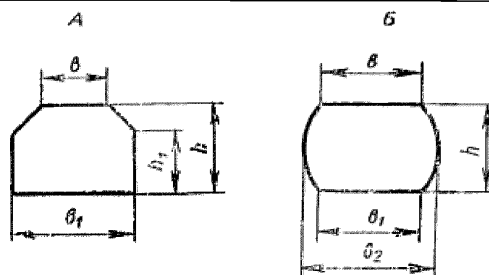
Поперечное сечение деревянных брусьев для стрелочных переводов:
